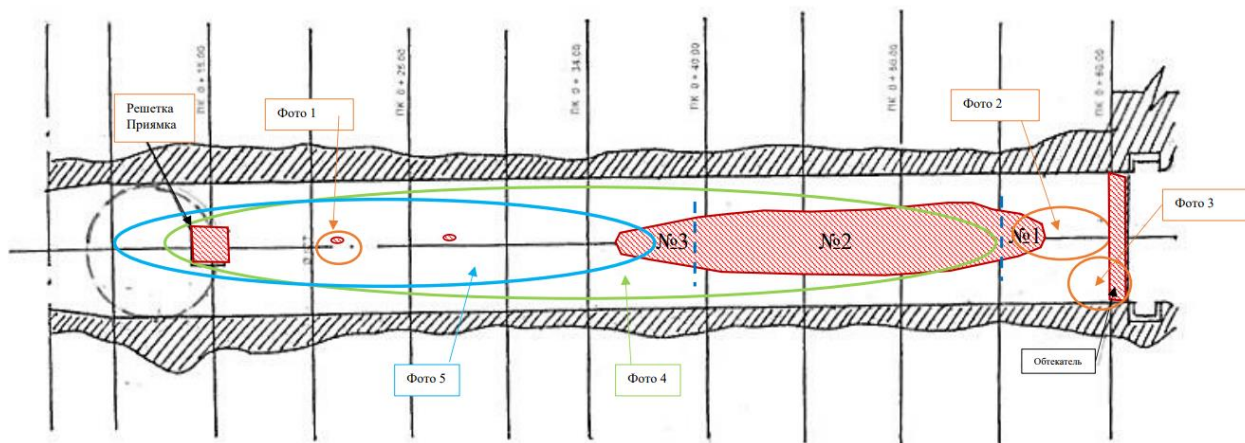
Продольный горизонтальный разрез лотковой части отсасывающей трубы 1Г,
